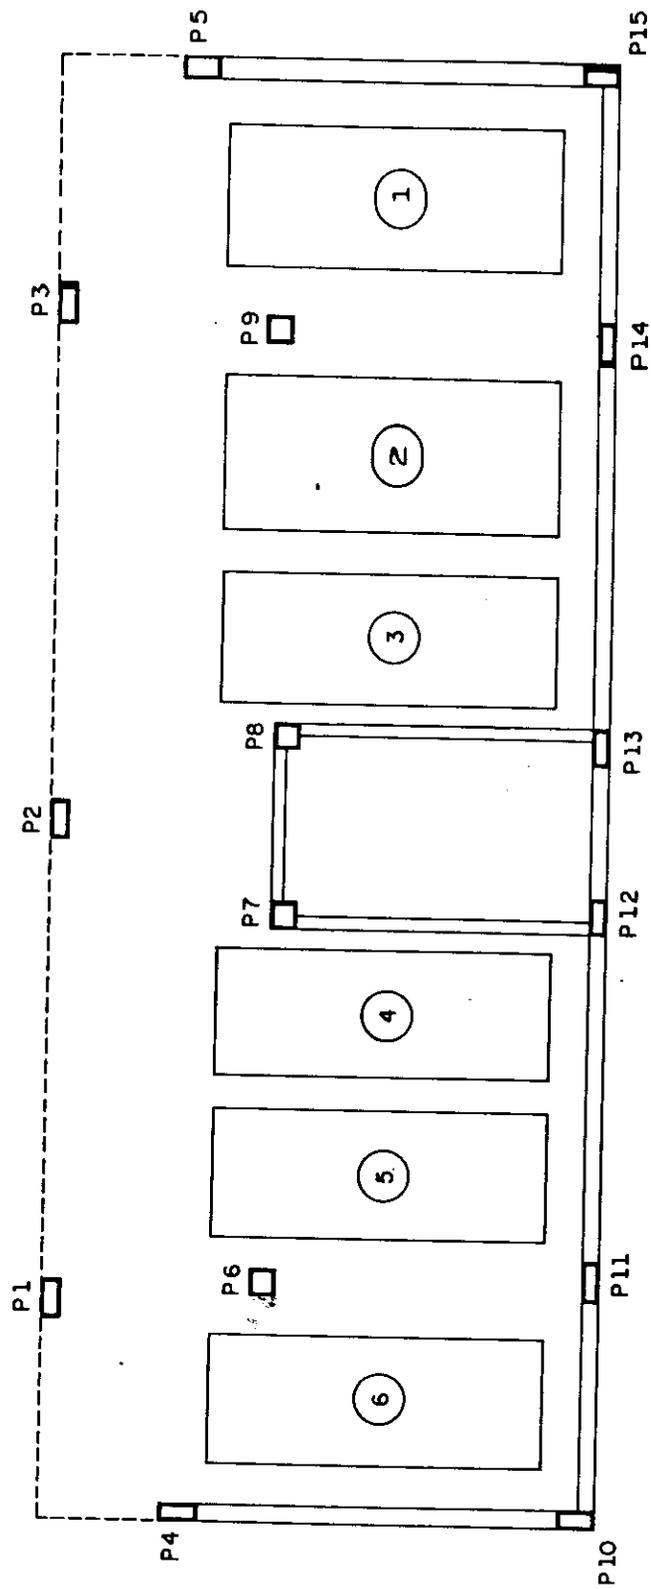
a - Estrutura II - Pavimento Tipo
